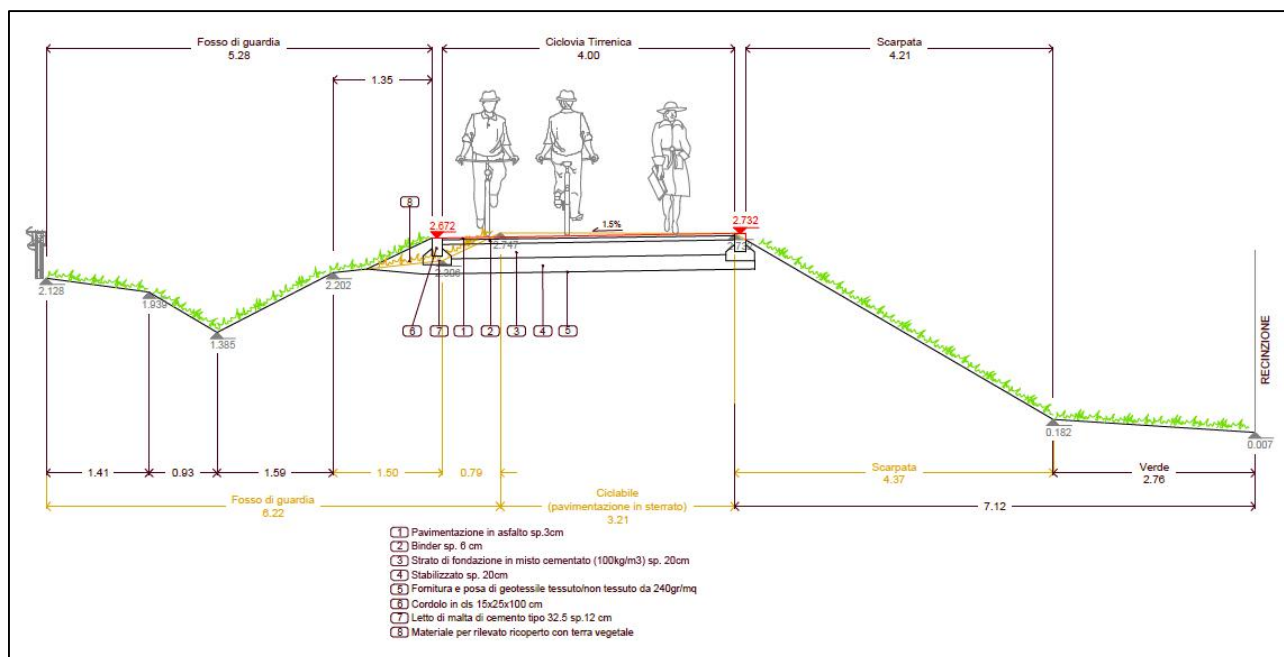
Sezione 19 di progetto trasversale SP delle Collacchie
